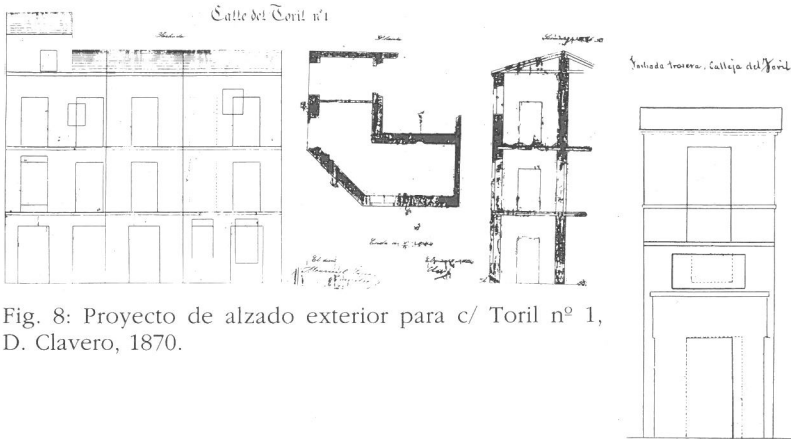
Proyecto de alzado exterior para c/ Toril nº 1, D. Clavero, 1870.
